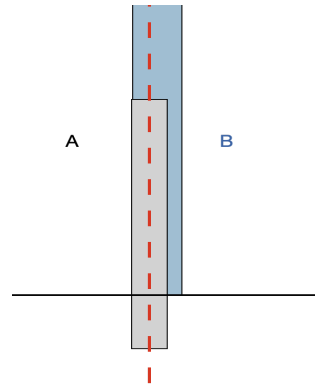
Schéma de mur mitoyen avec un exhaussement d'un mur trop vétuste et renforcé sur le fond réalisant la surélévation
